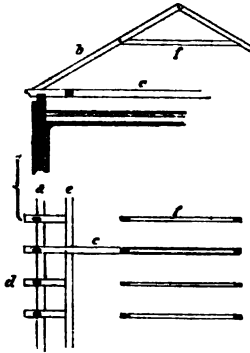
Querschnitt eines leeren Dachstuhles. a Mauerbank, b Sparrenhölzer, c Bundtram, d Stichbalken, e Wechsel, f Kehlbalcken.
